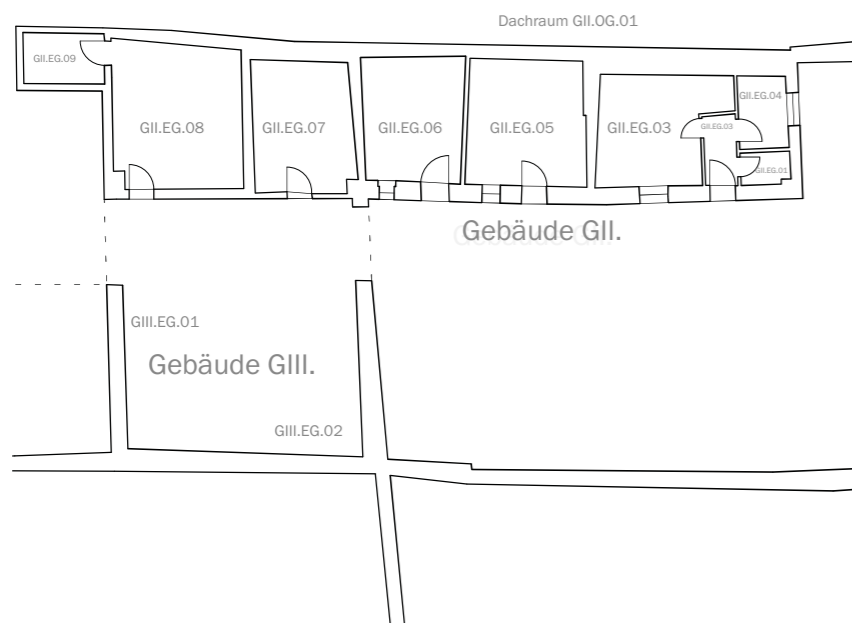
Grundriss Gebäude GII. 1:250
